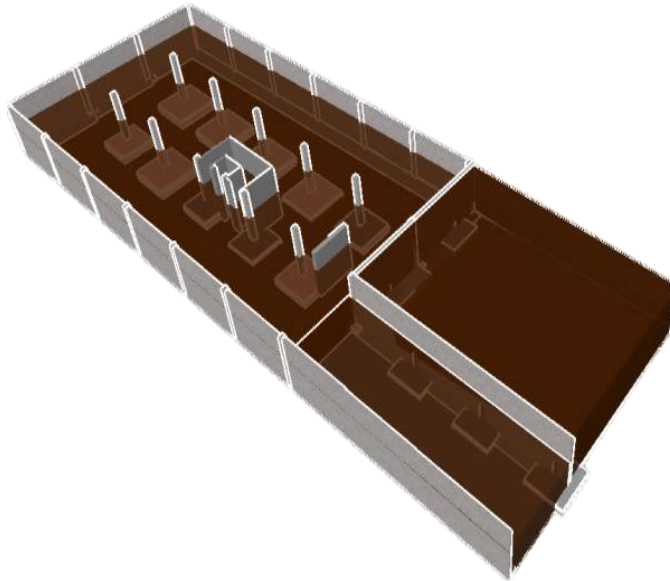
Modelo 3D de cimentación Autor: Carmen López
